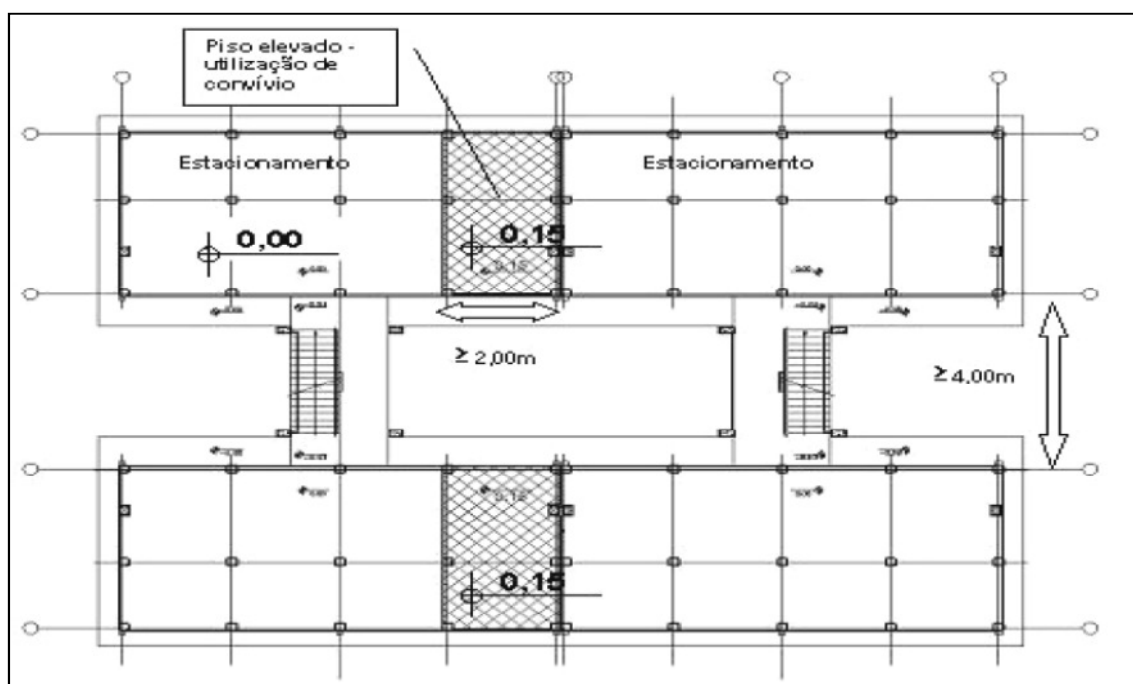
Edifício 05 pavimentos – Térreo Utilizado para convívio e estacionamento – Planta.
